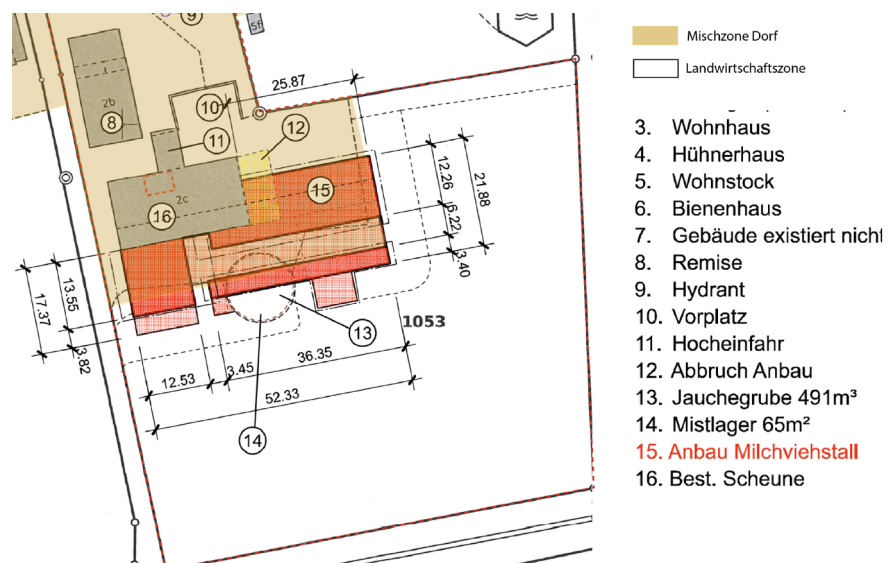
Abb. 2 Situationsplan des geplanten Um- und Anbaus im Bereich des Gebäudes Dorfstrasse 2c
